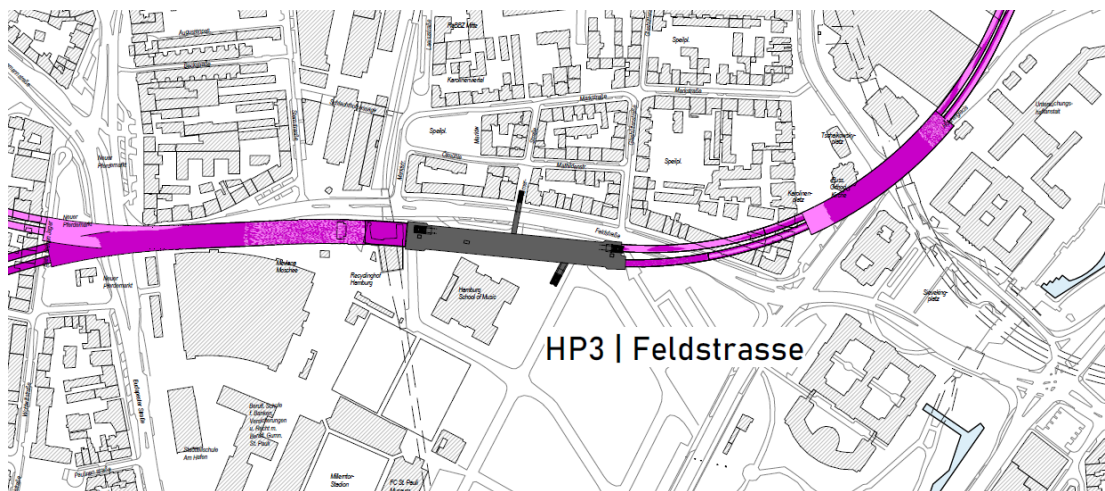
Lageplan Stationsbauwerk HP 3 Feldstraße, Variante 2 (pink/lila) (Variantenstudie).
